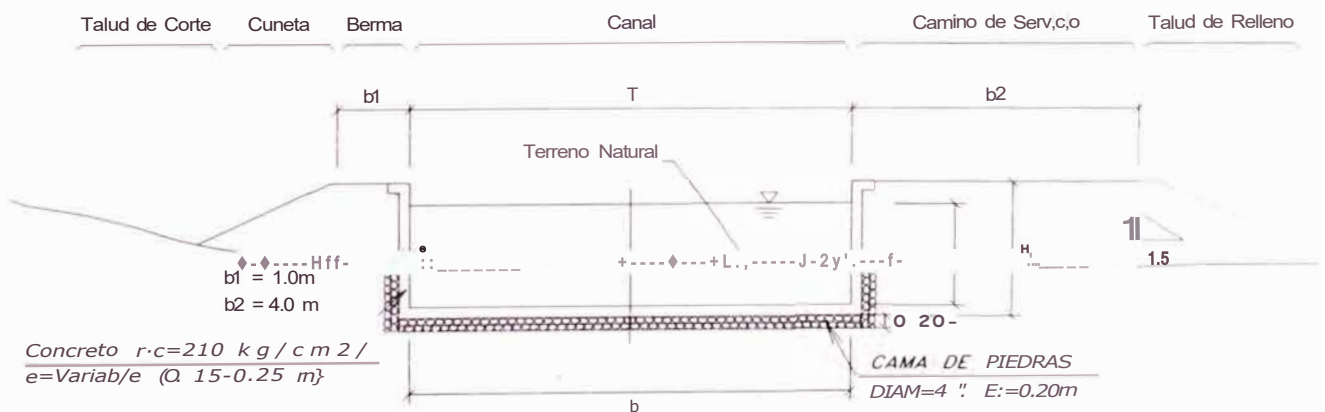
Sección Típica de Cama de Piedras en Relleno del Terreno en el Canal Rectangular
